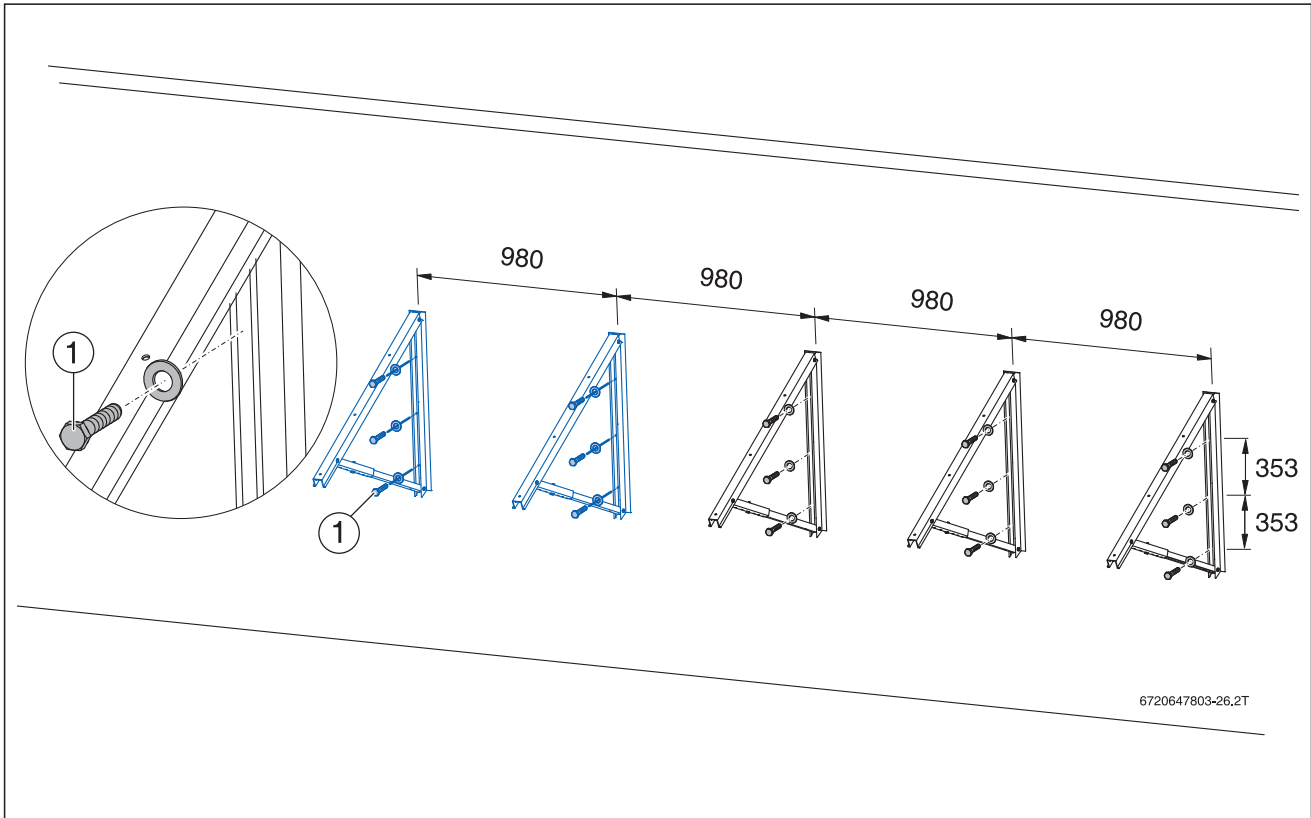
Fassadenmontage von 2 SKN4.0, SKT1.0 oder SKS5.0 mit Grund-Set Fassadenmontage und Erweiterungs-Set (blau); (Angaben in mm)
